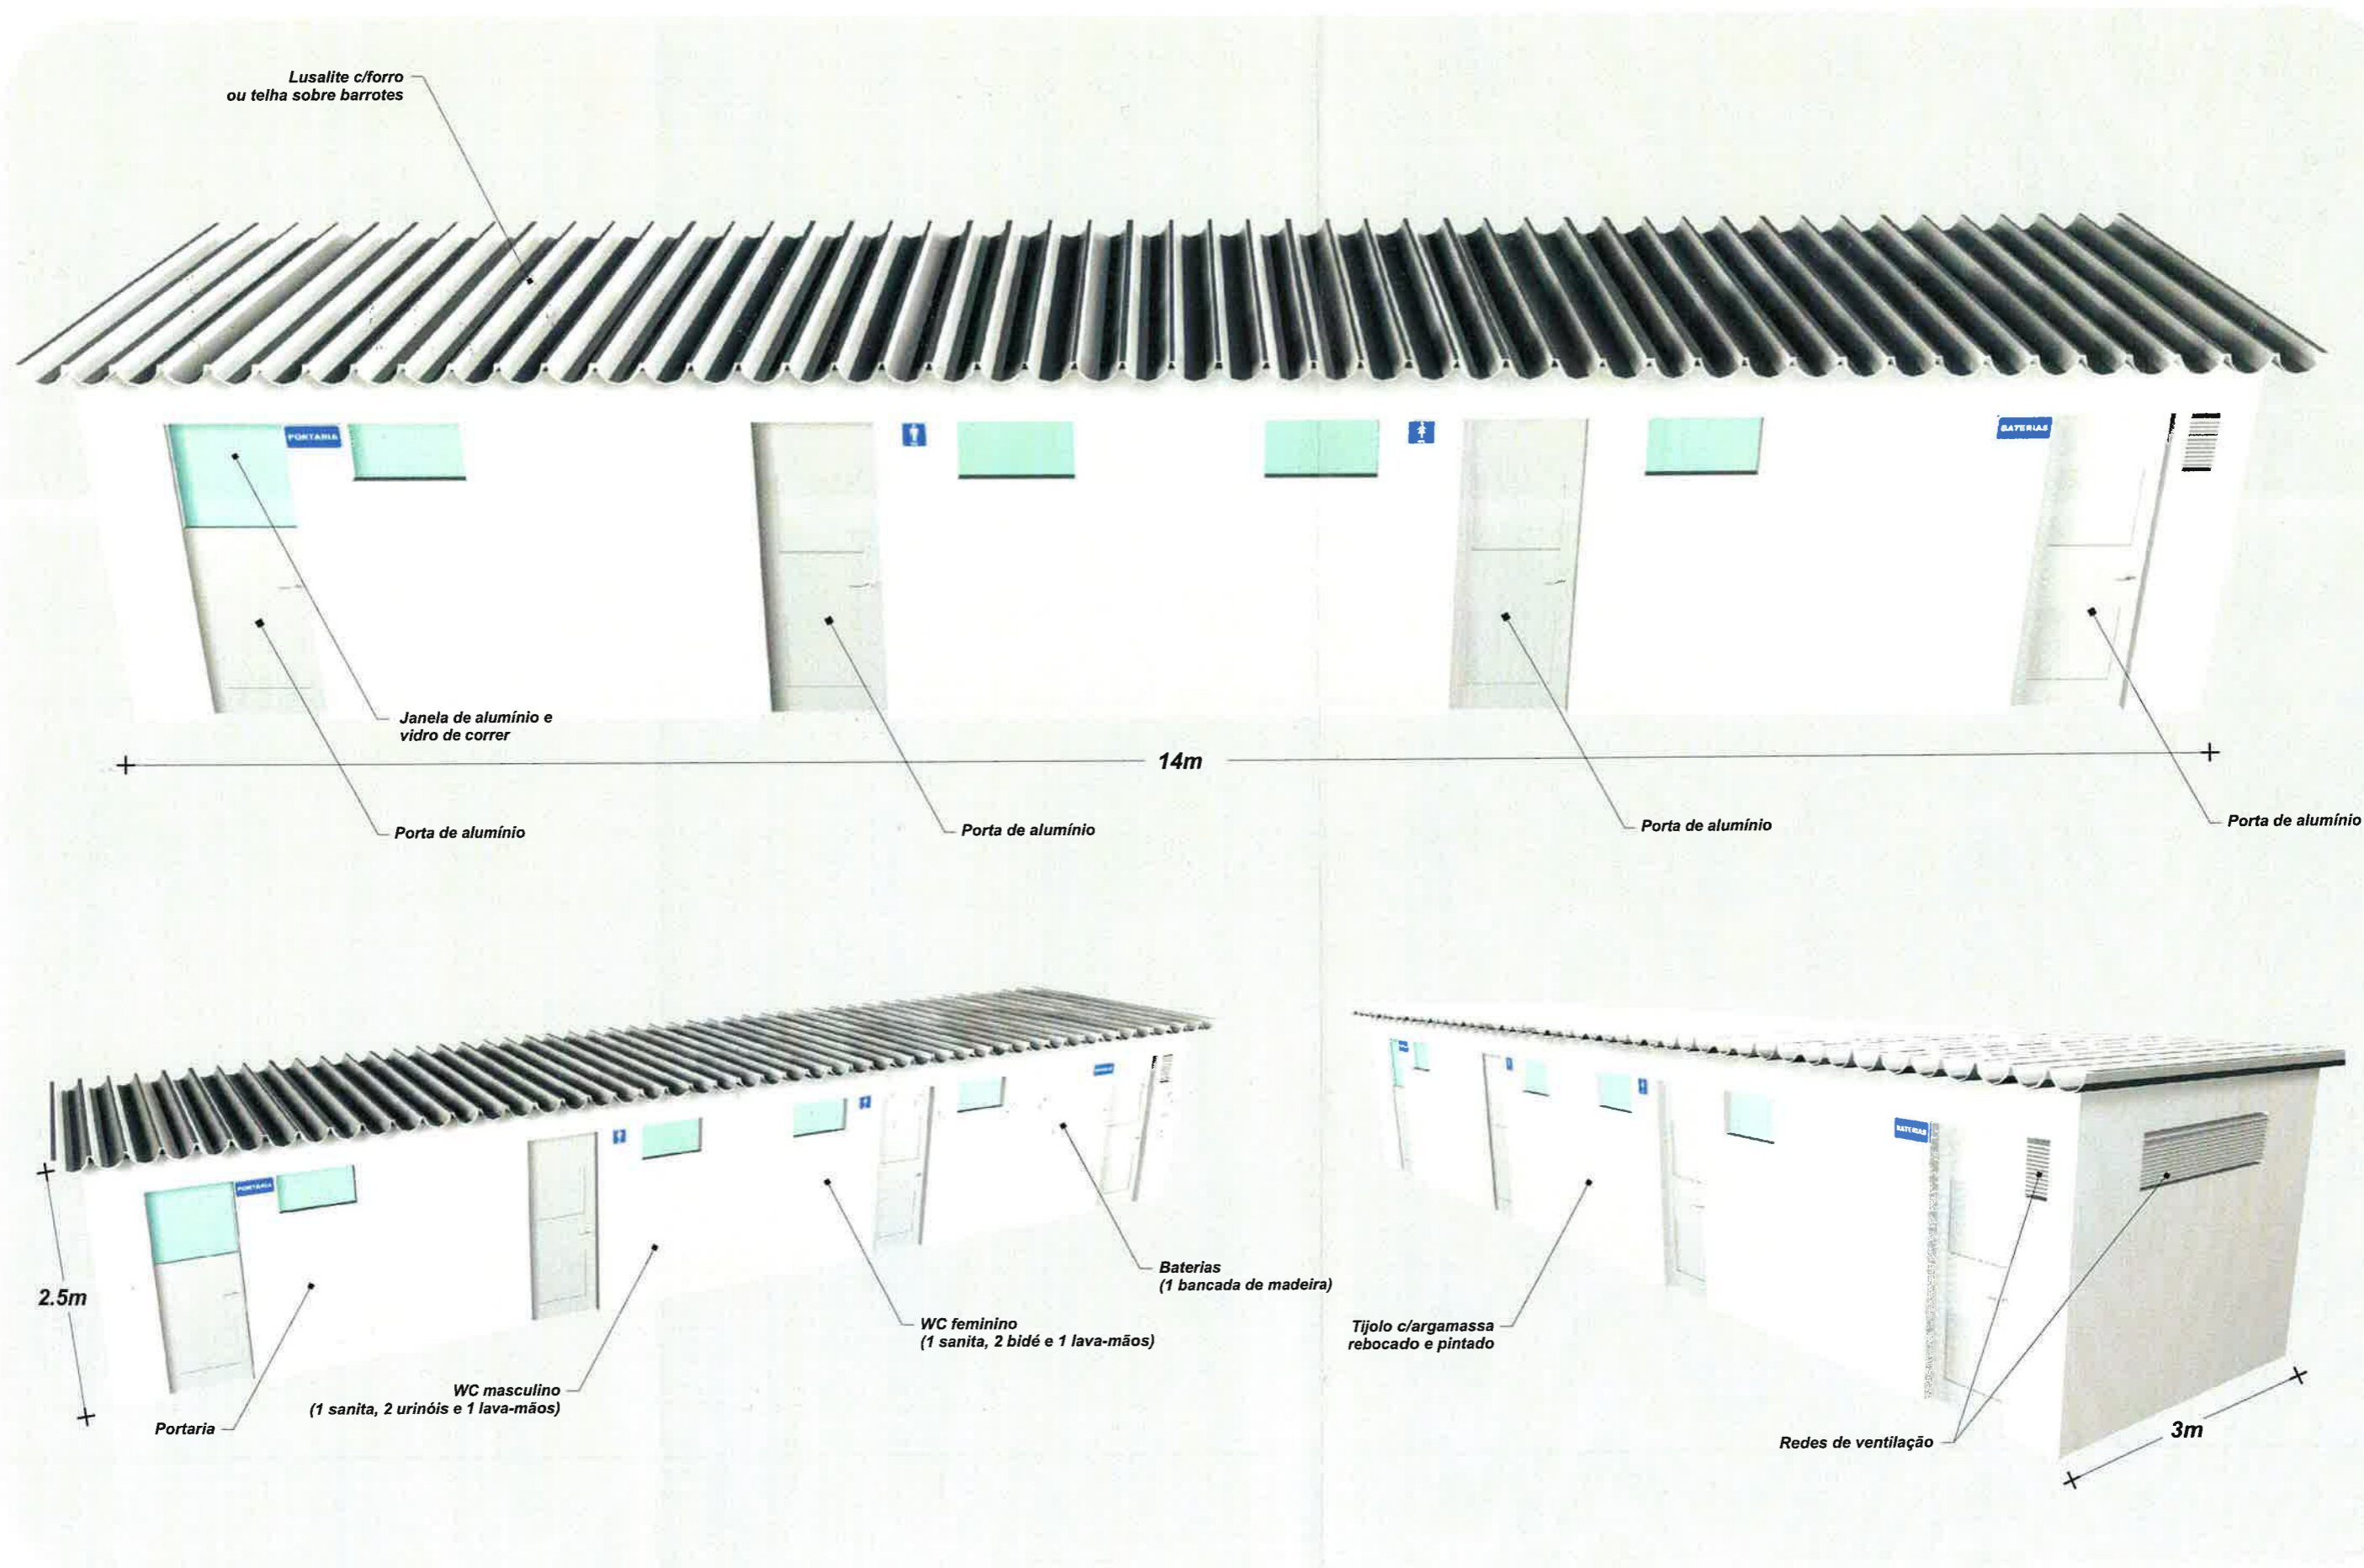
(Rev00) - Edifício de Apoio. Perspectivas esquemáticas
